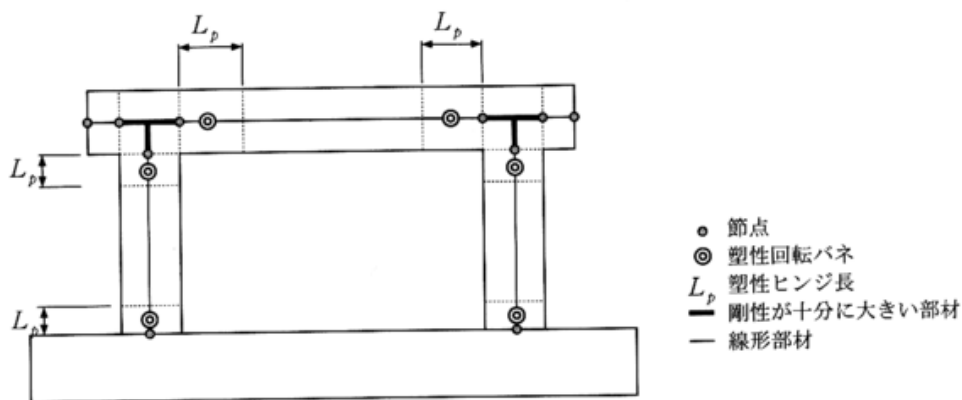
鉄筋コンクリートラーメン橋脚のモデル化
